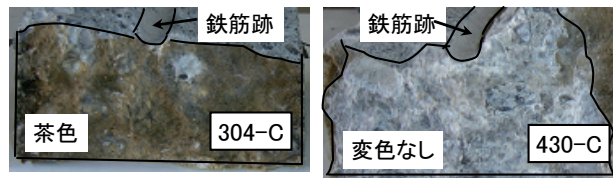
ひび割れ面の変色状況（暴露3.8年）
